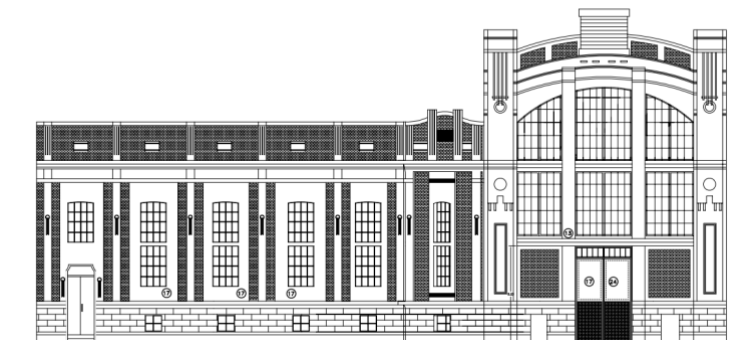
Fachada Subestación Mendoza. Fuente: EPE
